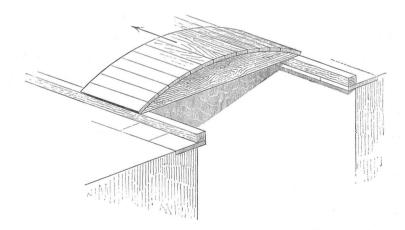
Cimbra móvil para la construcción de bóvedas tabicadas
